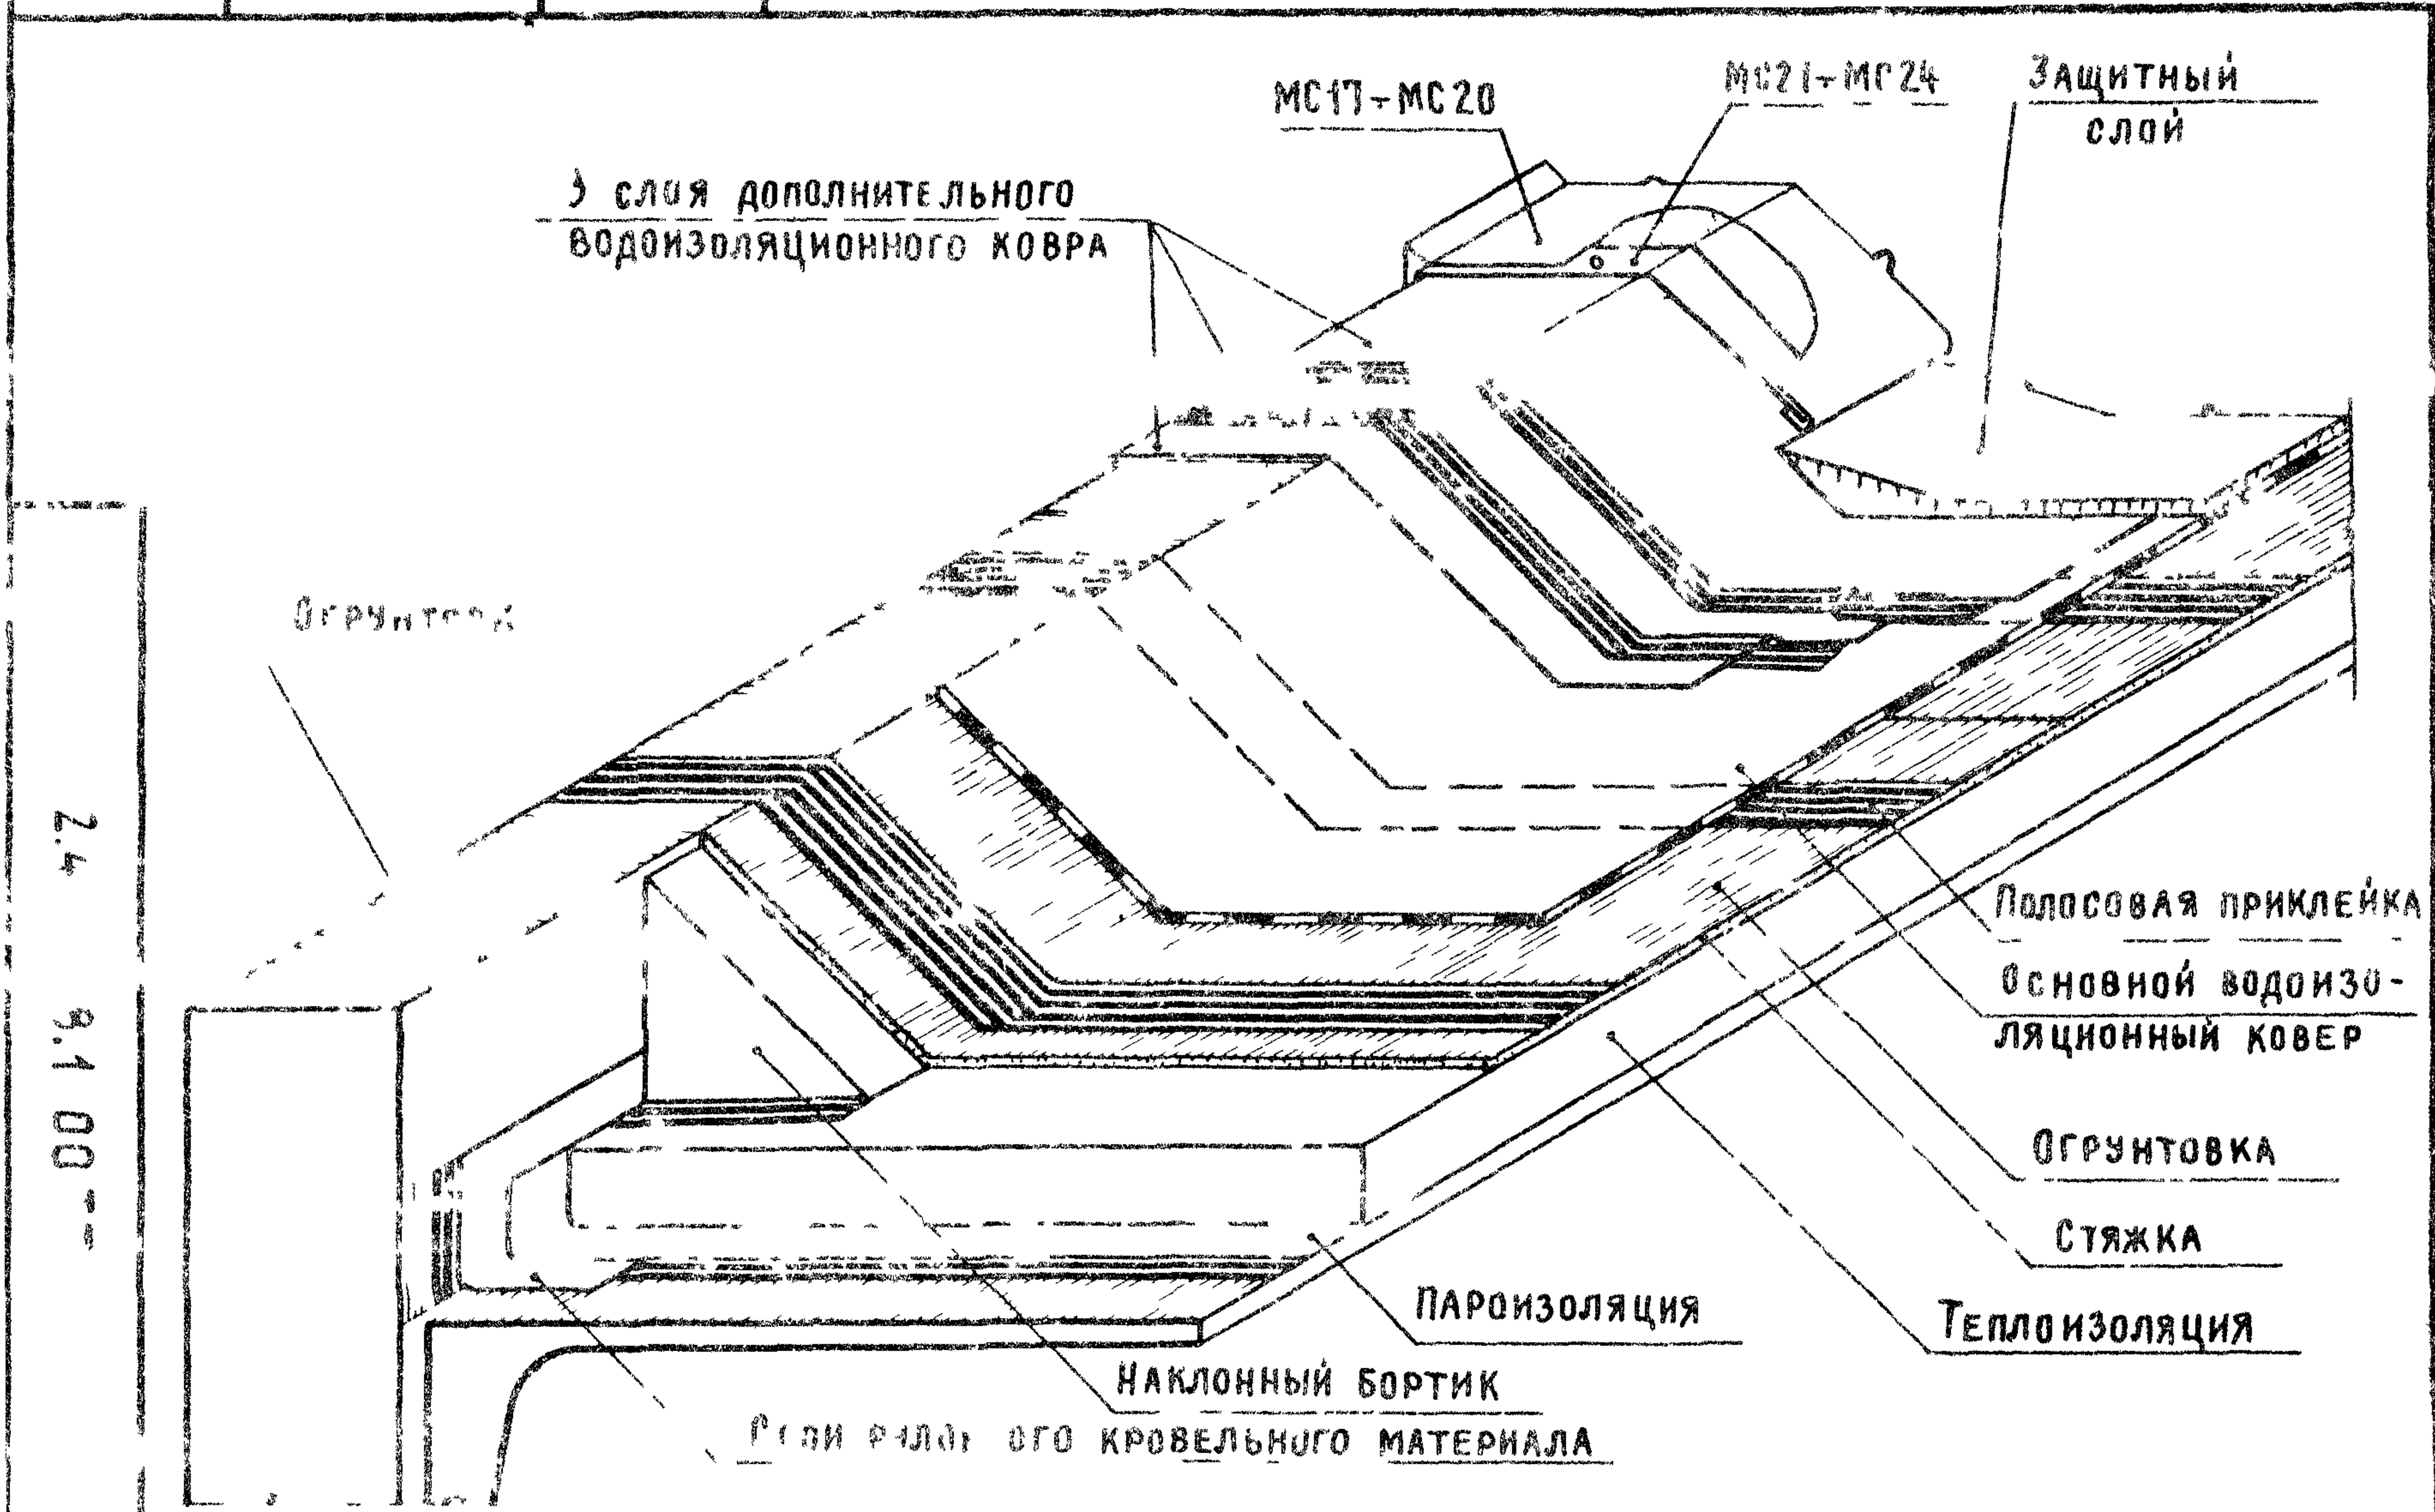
Парапет высотой до 200 продольной стены при уклоне кровли до 2,5% (с выходом водяных паров)
